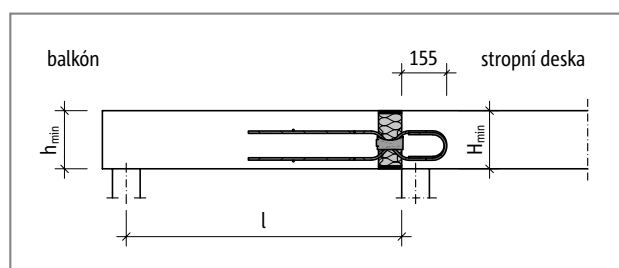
Schöck Isokorb® T typ QL-V1 až QL-V3: Statický systém
